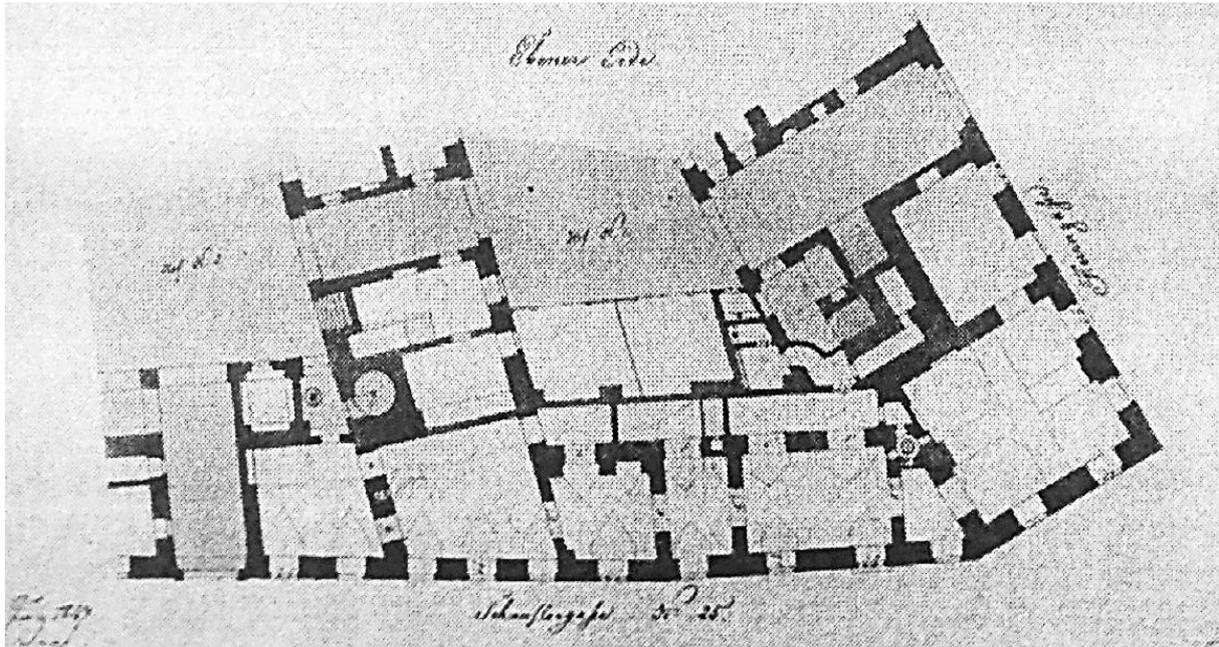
Grundriss des Cafe Griensteidl zu "Ebener Erde", Wien, 1847, Wiener Stadt- und Landesarchiv
